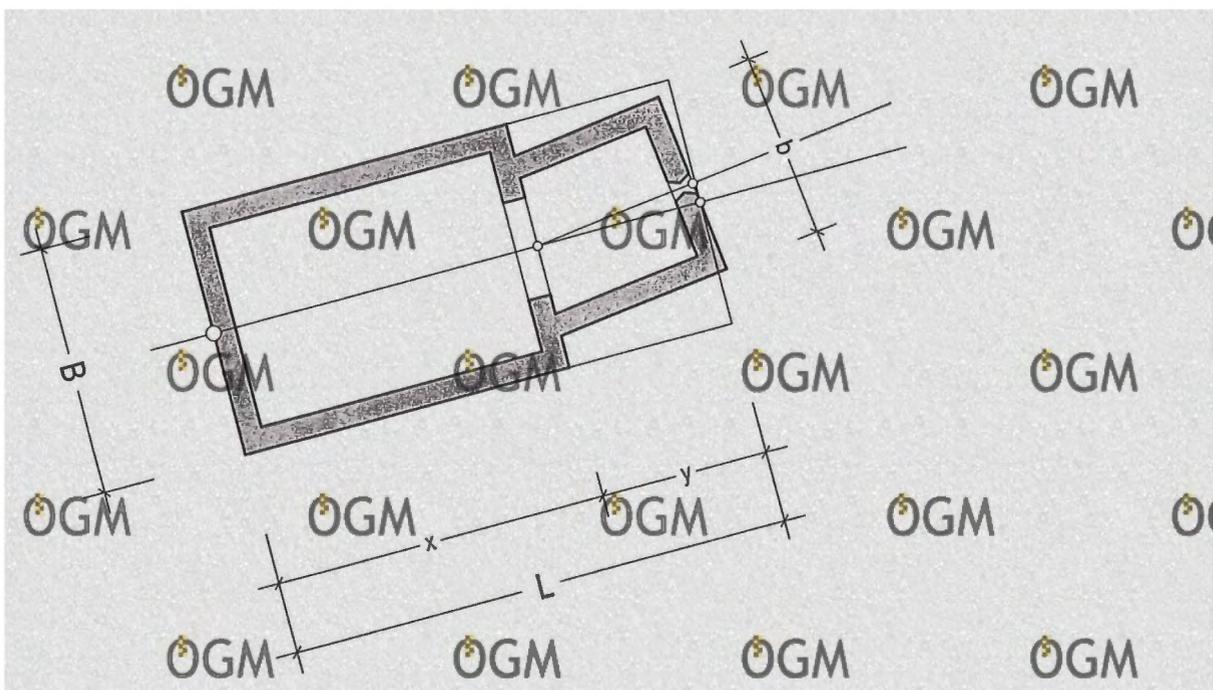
Absteckung des Schnurgerüsts (Konstruktionsschritt 7).
